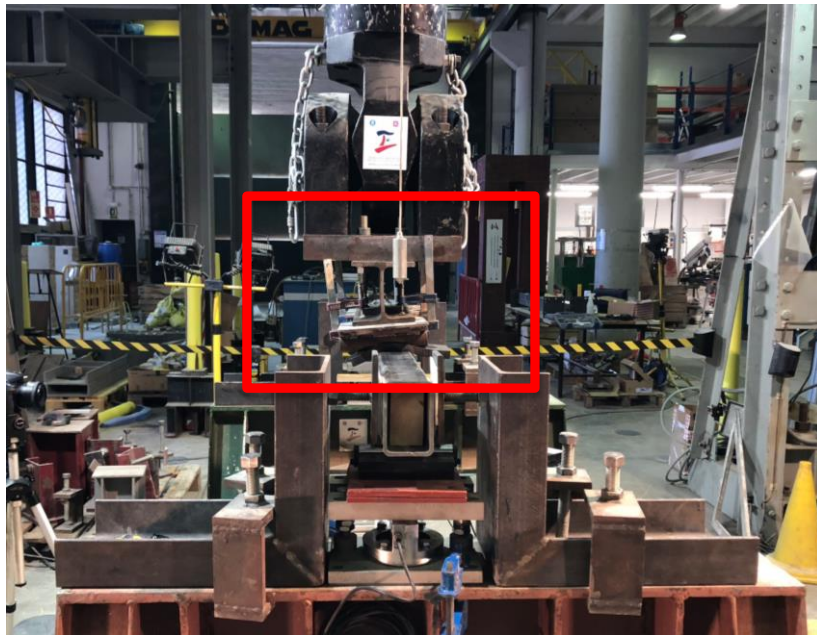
Fallo de la viga cargadero durante el ensayo de la viga S1
